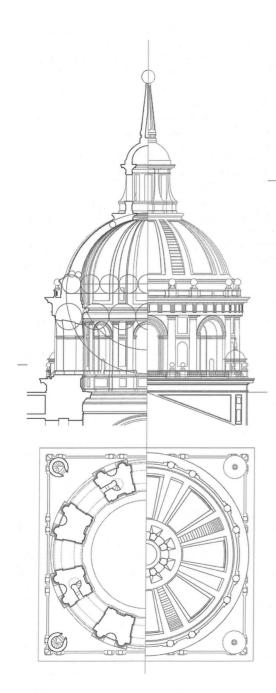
Plantas a dos niveles, sección y alzado de la cúpula, fruto del levantamiento realizado para este trabajo
